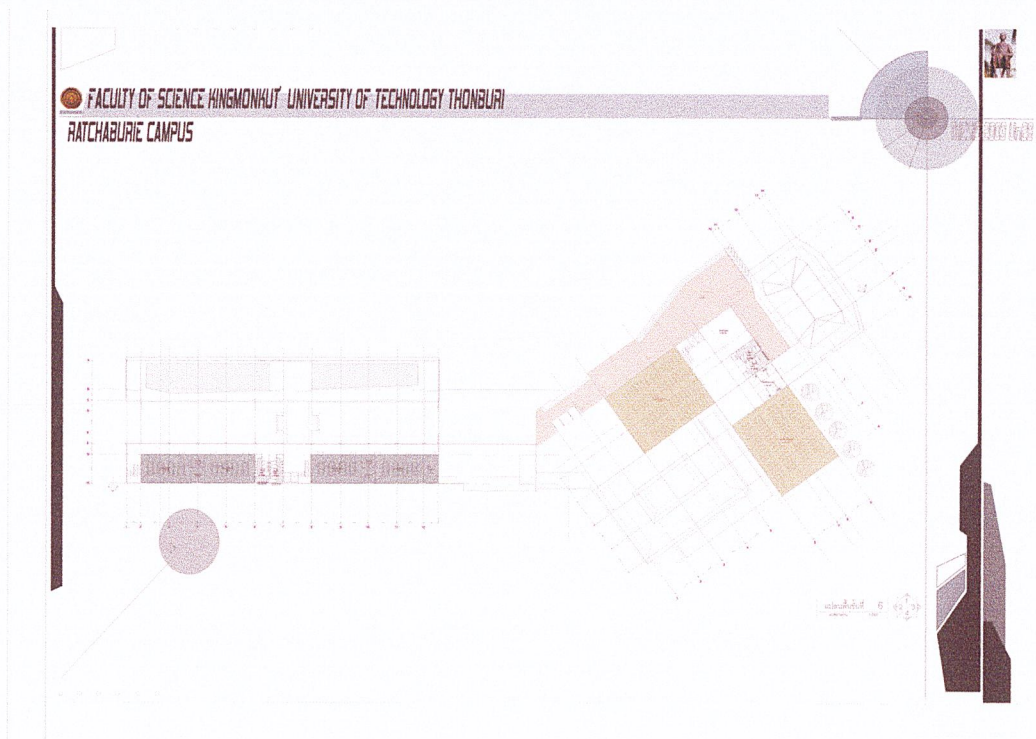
แสดง chart 3 rd floor plan
